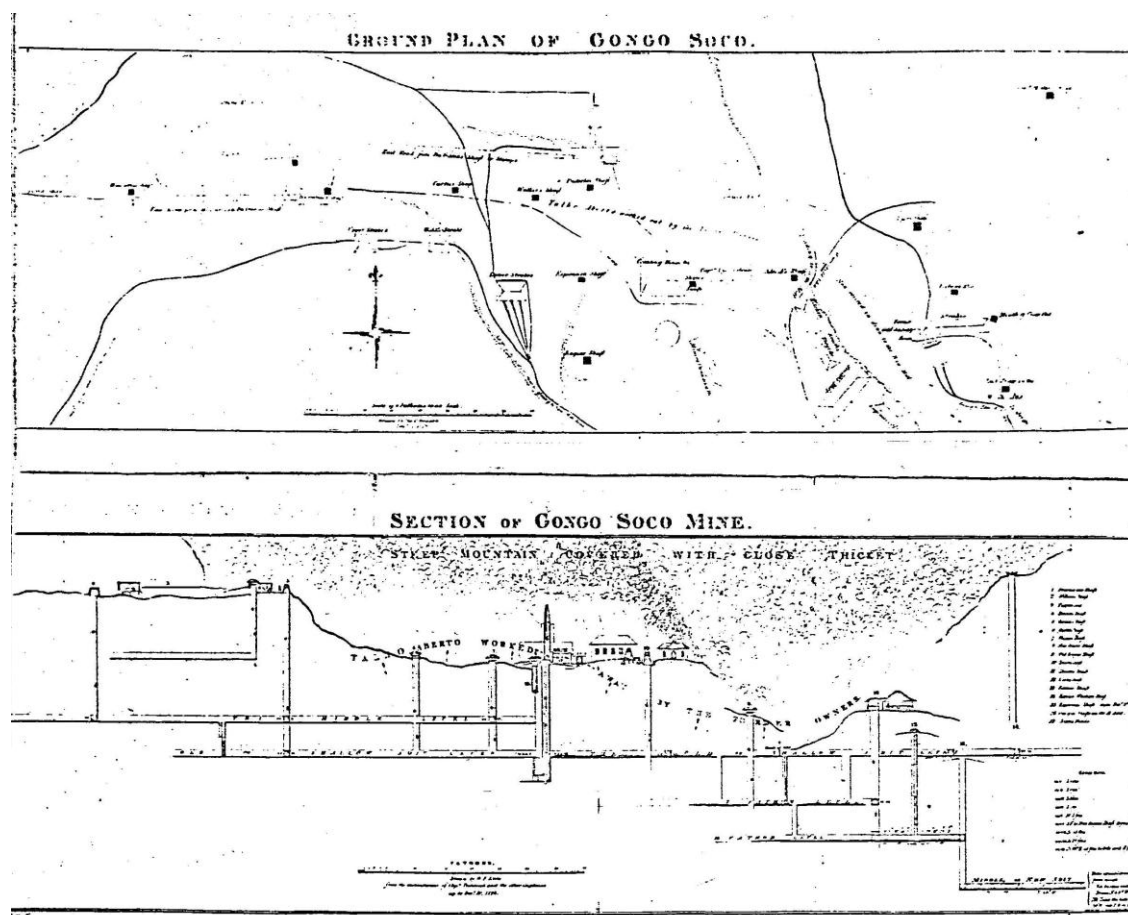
planta da mina publicada em um relatório do 2º semestre de 1828
